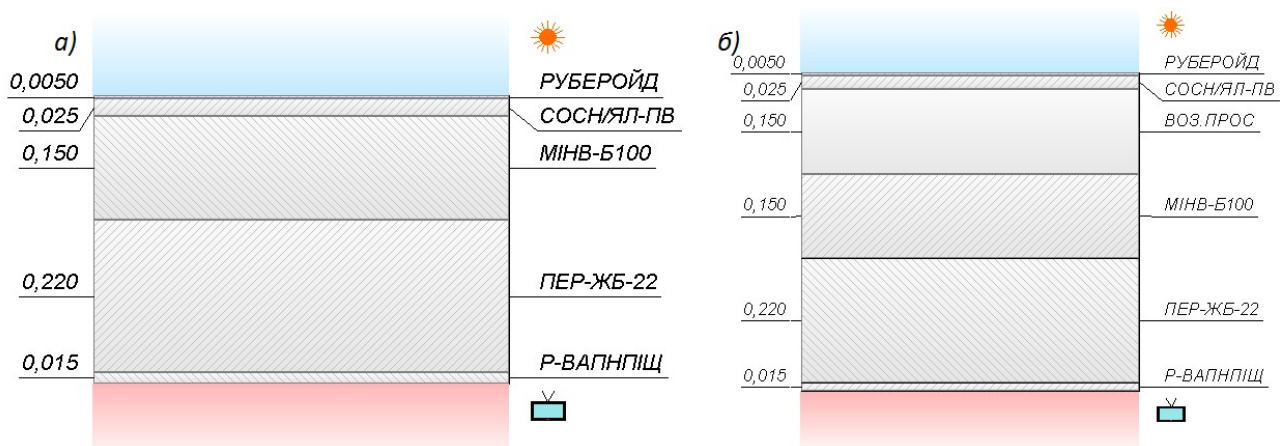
а) Конструкція горищного перекриття; б) конструкція суміщеного перекриття
